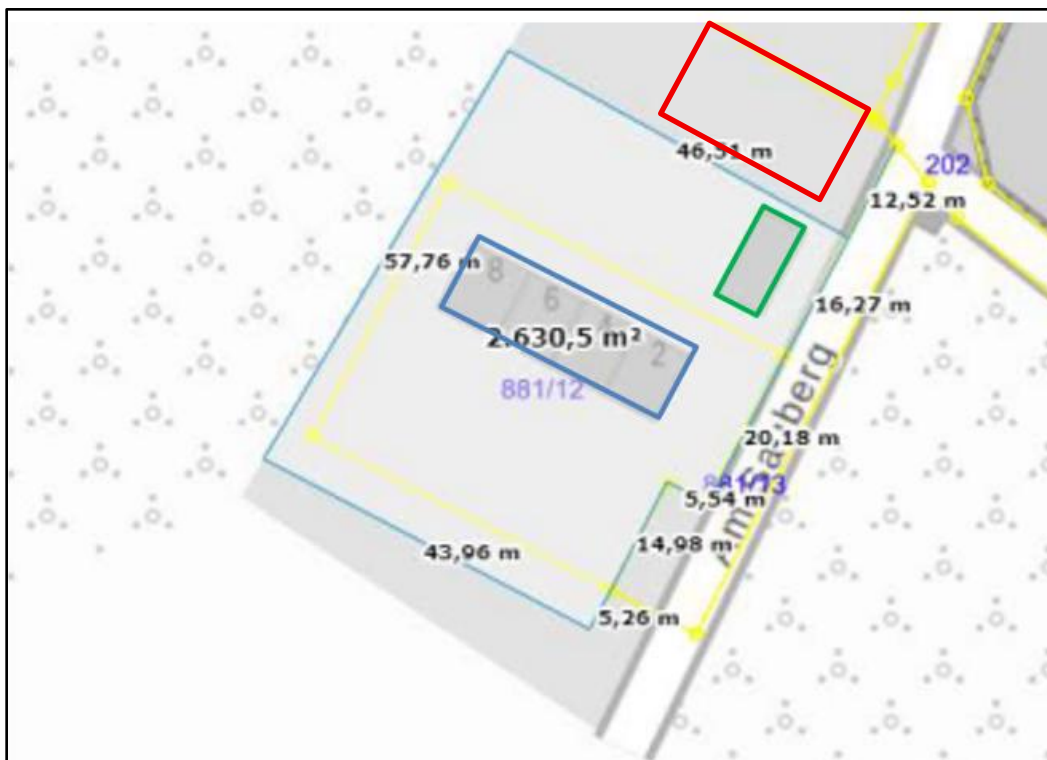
Grundstück 881/12 mit den bestehenden Reihenhäusern (blau umrandet) und den sanierungsfähigen Garagen (grün umrandet). Rot umrandet der geplante Parkplatz (Lage ungenau). (Quelle: Lageplan des Auftraggebers, verändert).
